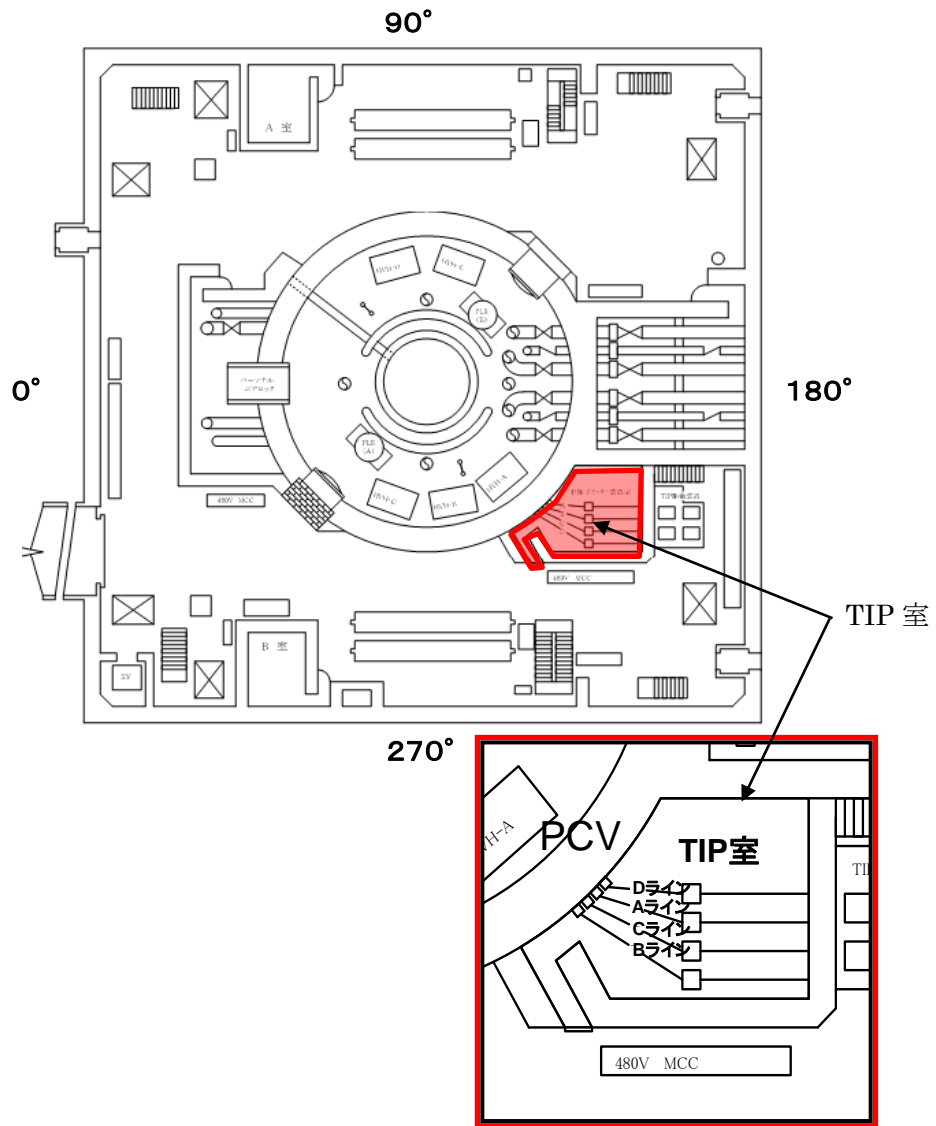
TIP室配置図（平面図）（2号原子炉建屋1階）
